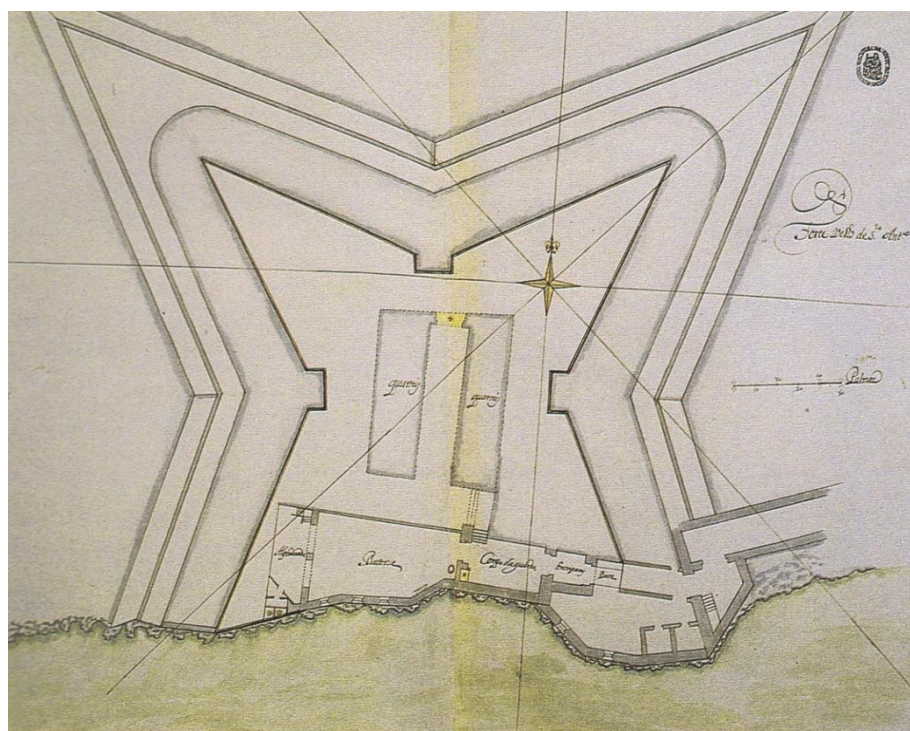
| Planta de Santo António da Barra, Mateus do Couto, 1693
